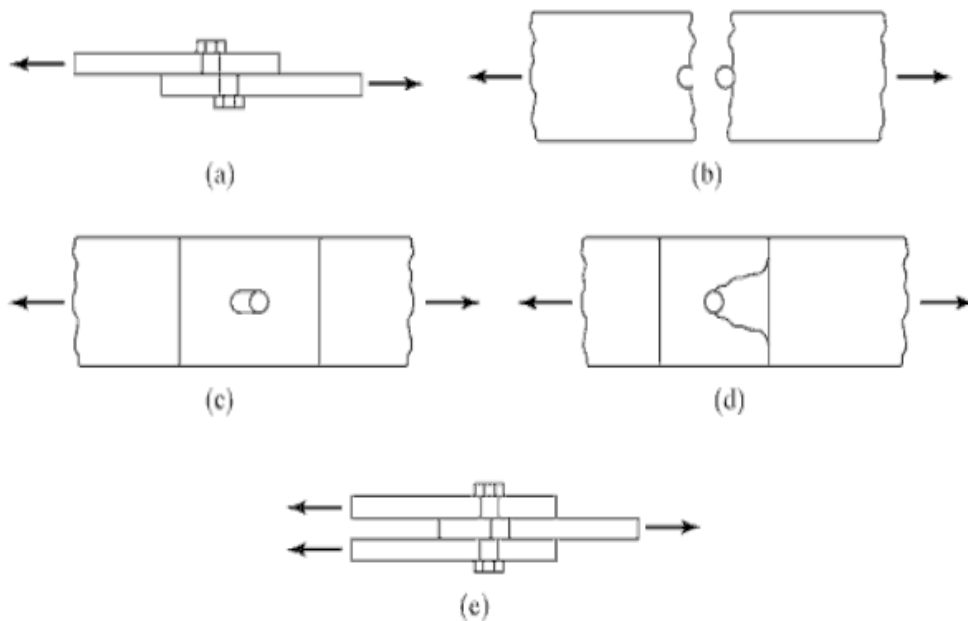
a) Junta traslapada b) Junta a tope <sup>28</sup>
